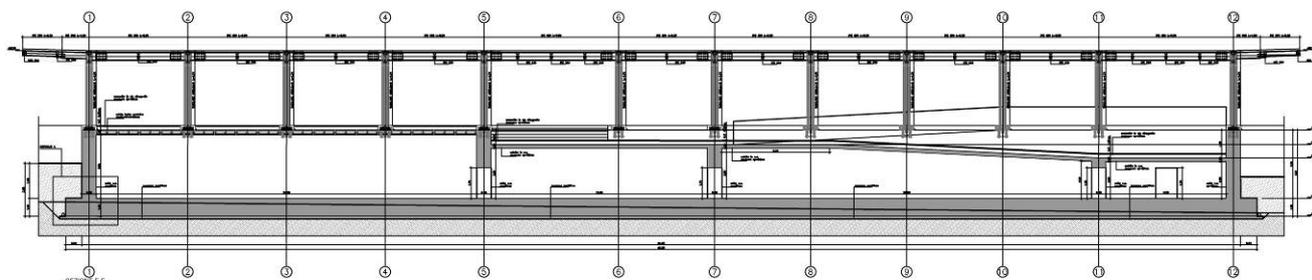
Sezione longitudinale tipo dell'edificio fermata
